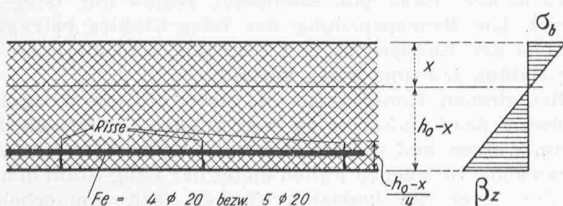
Rissbildung in einer schwach armierten Eisenbetonwand
